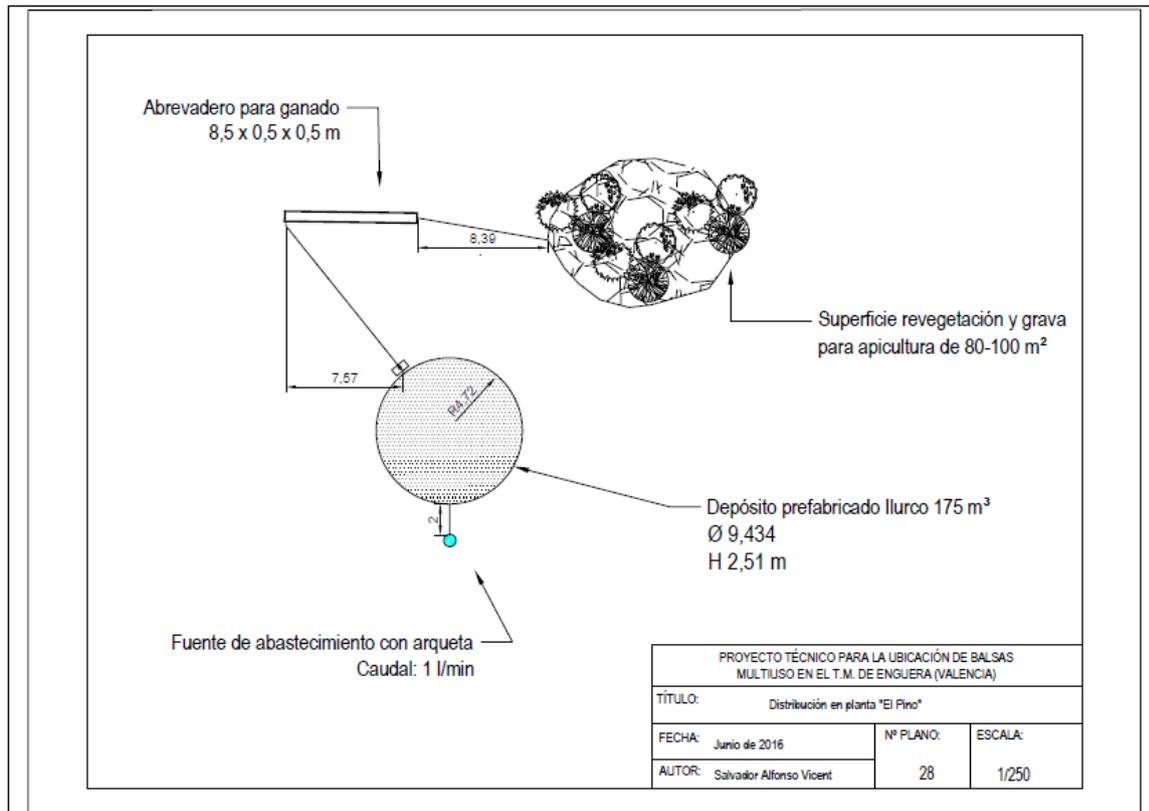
Distribución en planta "El Pino". Fuente: elaboración propia con Autocad
